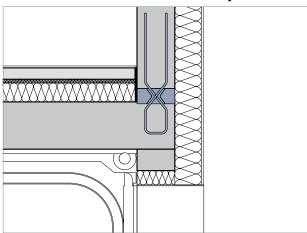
Sconnex® type W pour mur extérieur et isolation sur la dalle au-dessus d'une entrée de garage souterrain Le système Schöck Sconnex® type W est particulièrement adapté à toutes les zones dans lesquelles les différences de température entre l'air intérieur et l'air extérieur sont très grandes (par exemple dans la zone d'entrée d'un garage souterrain). Pour pouvoir renoncer en cet endroit à un encadrement épais de la construction par du matériau isolant, le niveau d'isolationprincipal peut être déplacé vers l'intérieur et le nœud constructif qui se forme dans le détail de raccordement du mur extérieur peut être supprimé directement par l'agencement du système Schöck Sconnex® type W.
